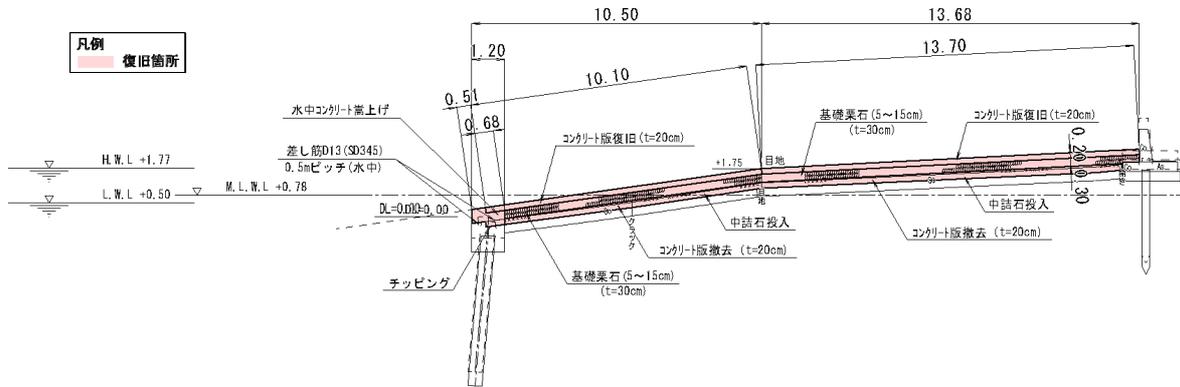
塩釜港区\_要害船揚場の断面図(復旧後)
